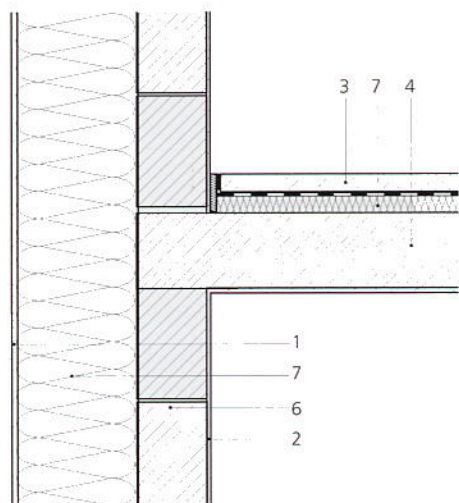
Coupe du mur extérieur - dispositif d'appui en béton armé
